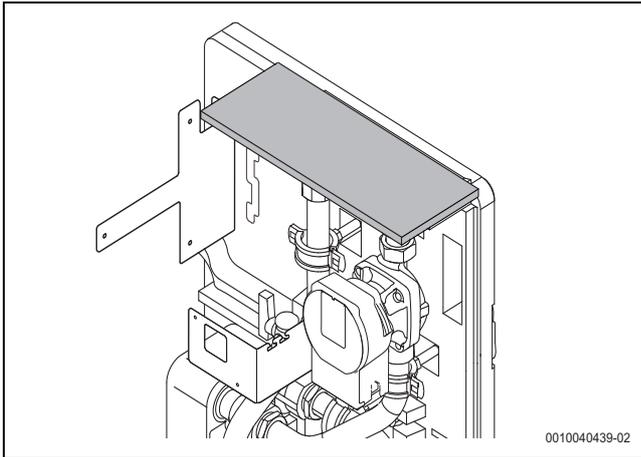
Anschlüsse oben während der Montagearbeiten abdecken
